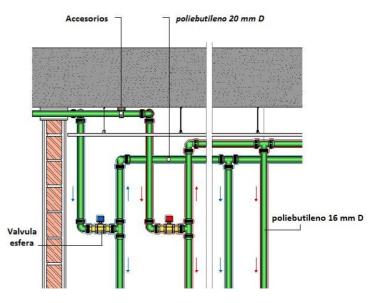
Detalle Fontanería y llaves de corte 2016, CYPE
